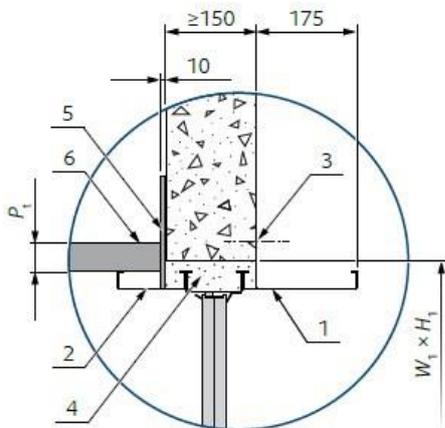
(EI120S) Sezione trasversale di ① Installazione umida in parete rigida
